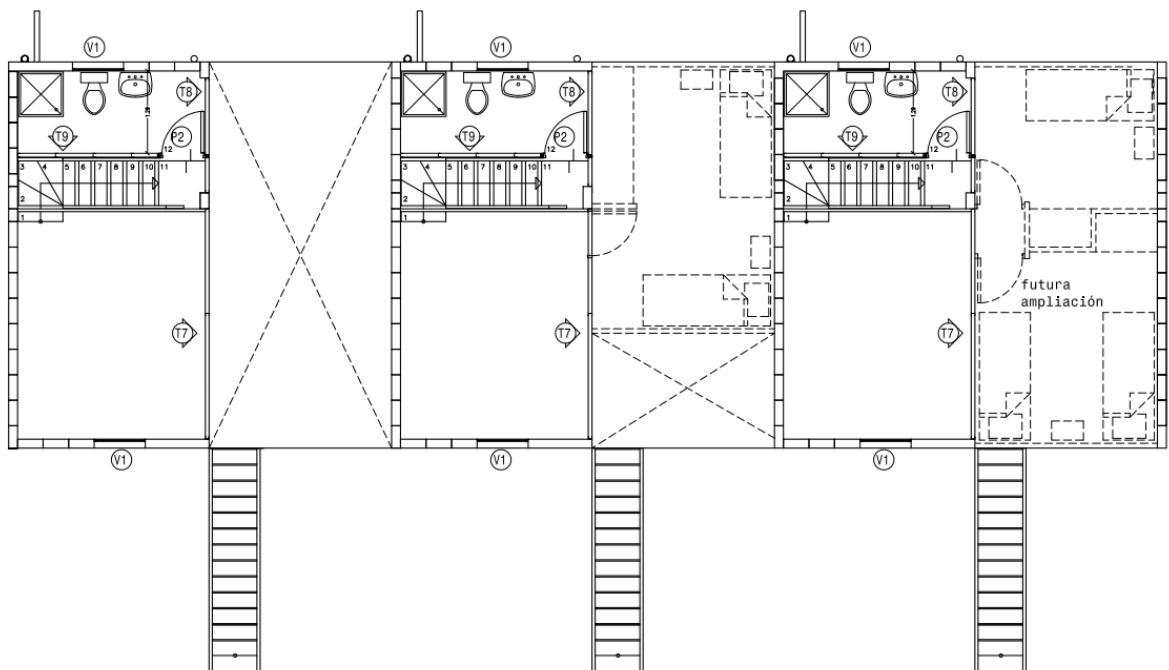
Planta terceiro nível. Fonte: Projeto Elemental – Quinta Monroy, 2016.
